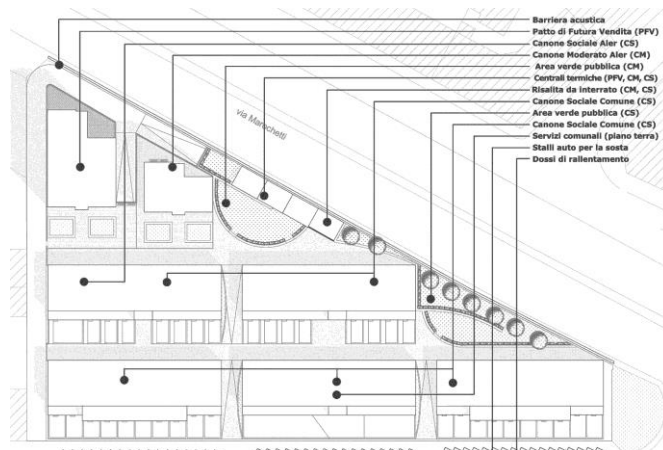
Planimetria del progetto proposto dal gruppo di ricerca con indicazione delle funzioni
